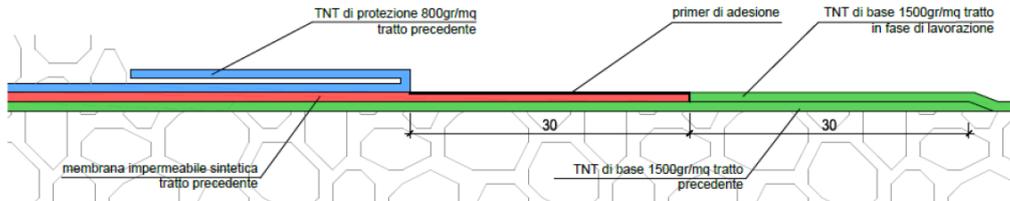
Posa dell'impermeabilizzazione: Particolare della ripresa di posa
